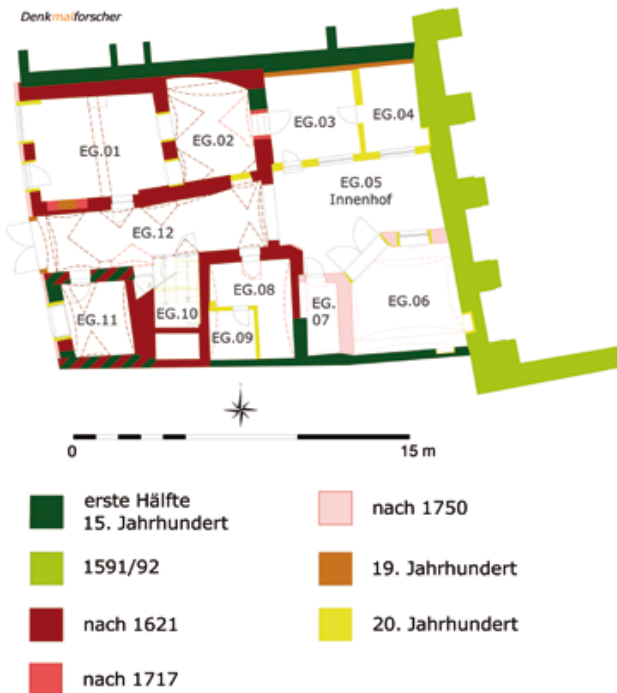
St. Pölten, Bürgerhaus. Baualterplan des Erdgeschoßes.
